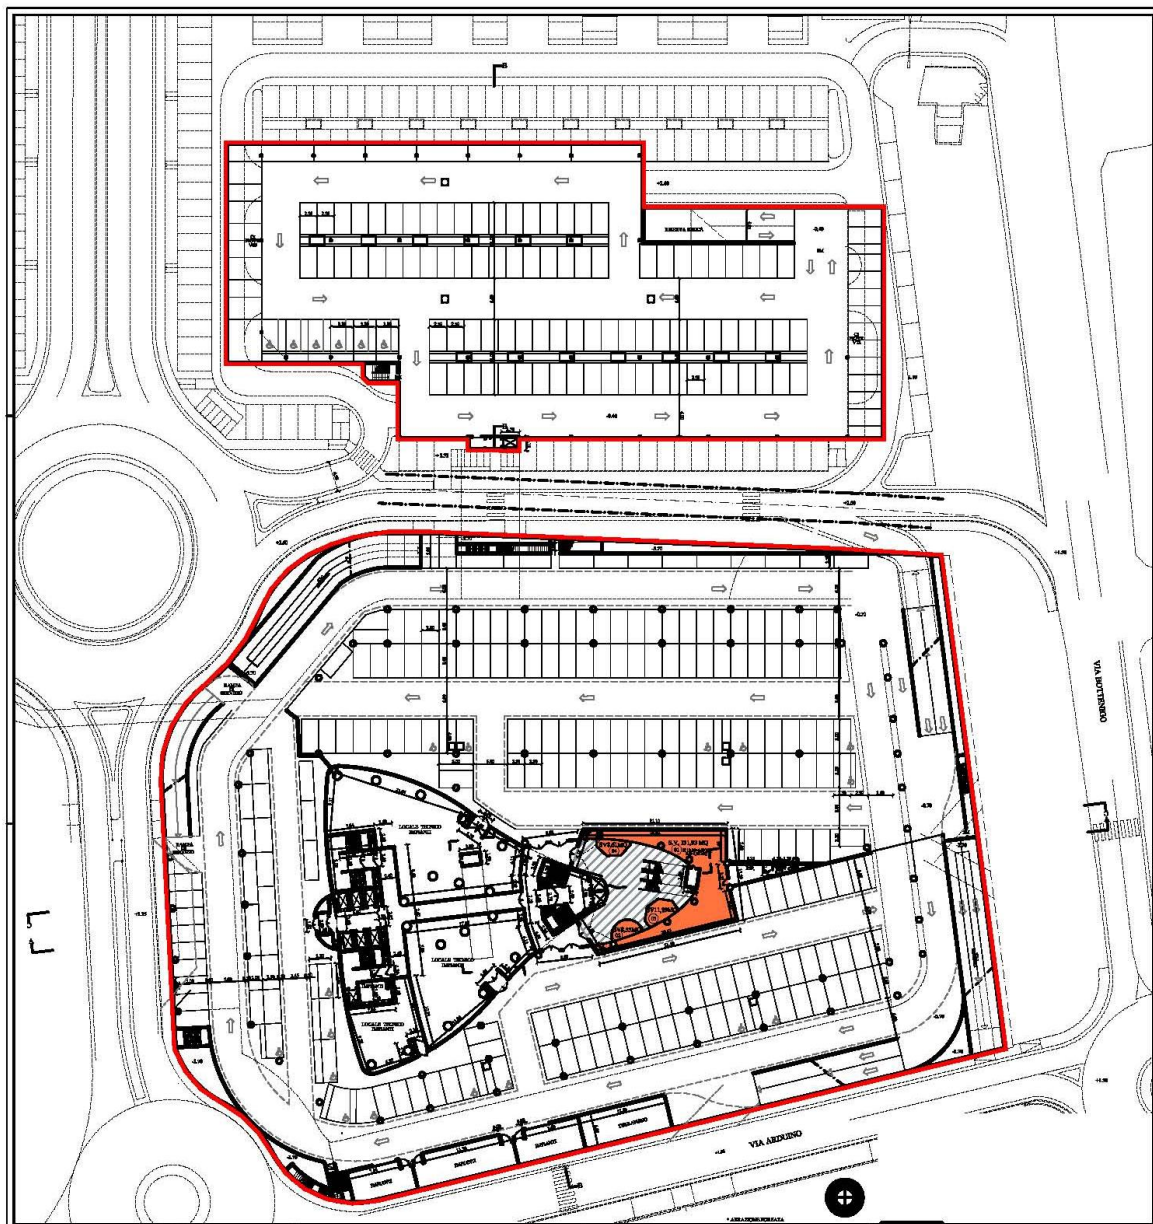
planimetria dei piani interrati con l'individuazione dell'area di scavo
